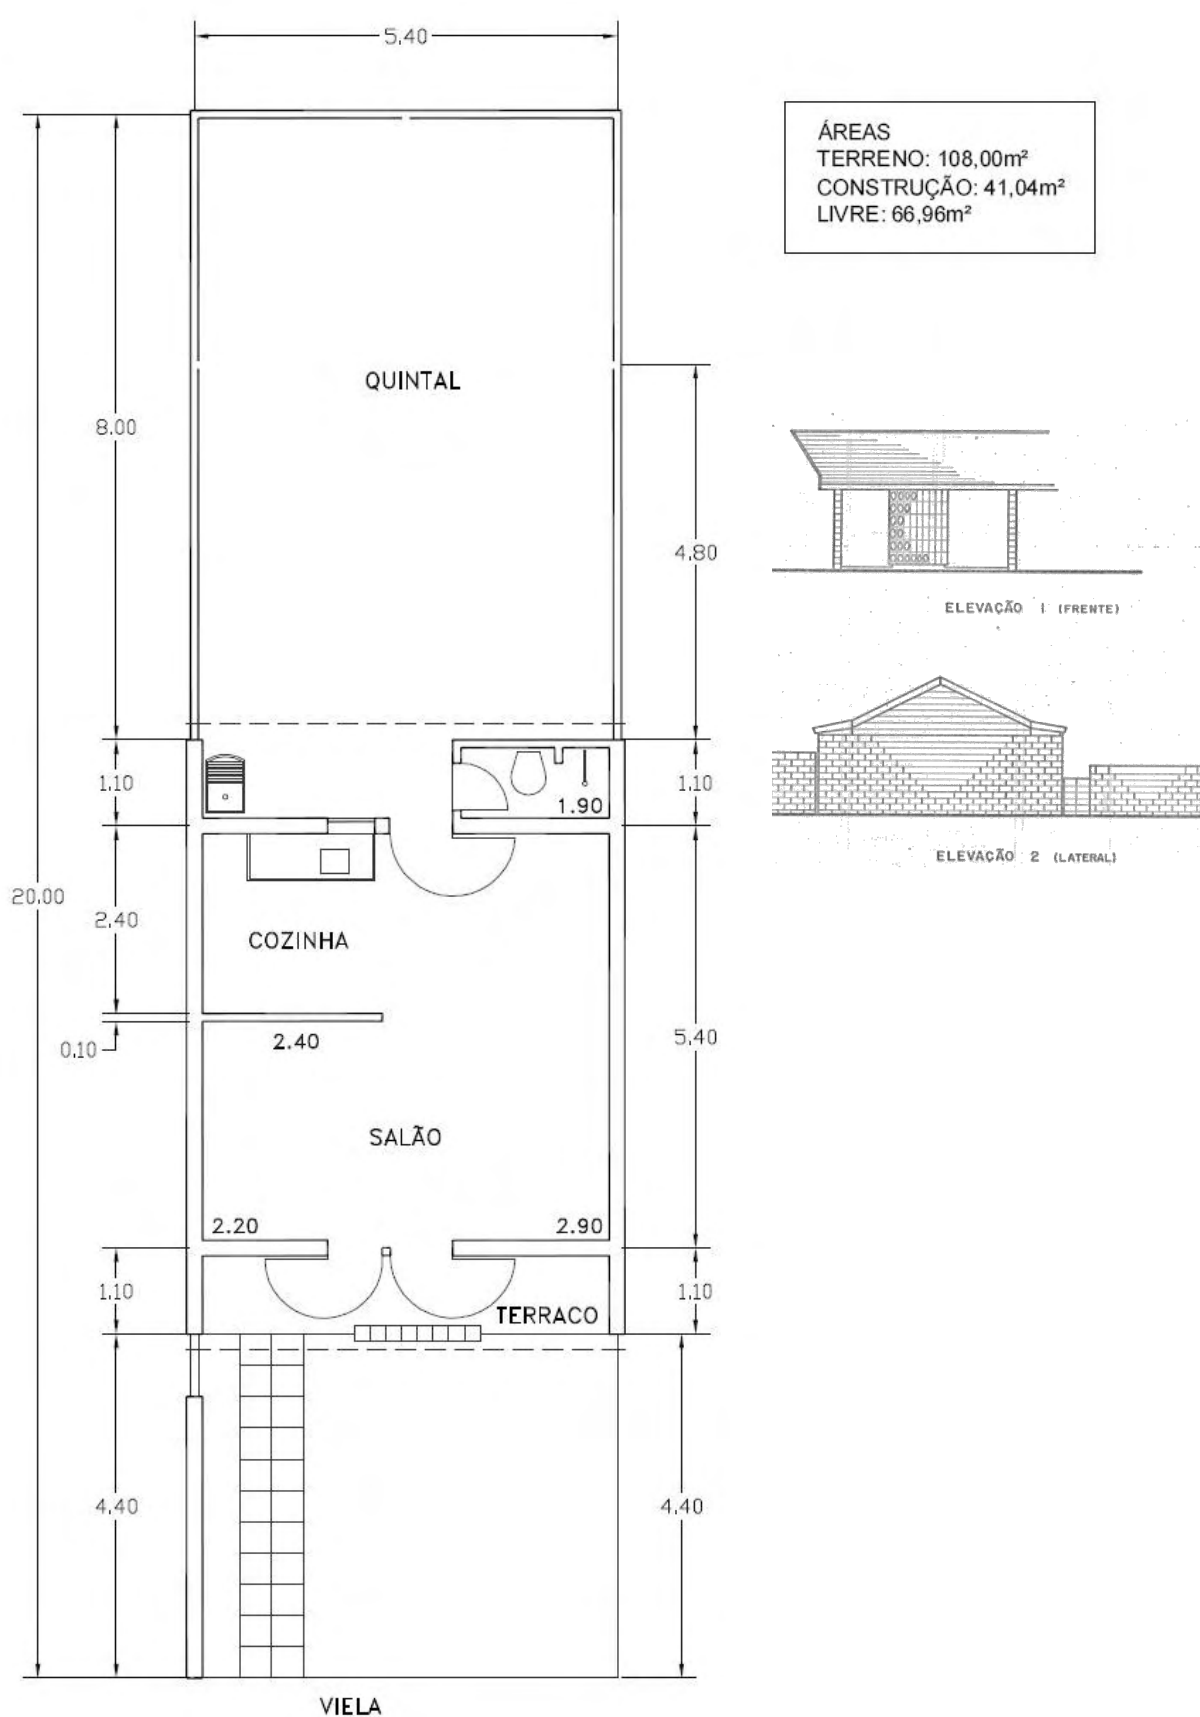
Figura A – Planta e elevações da casa tipo 1(MANGE; KATO, 1963)
